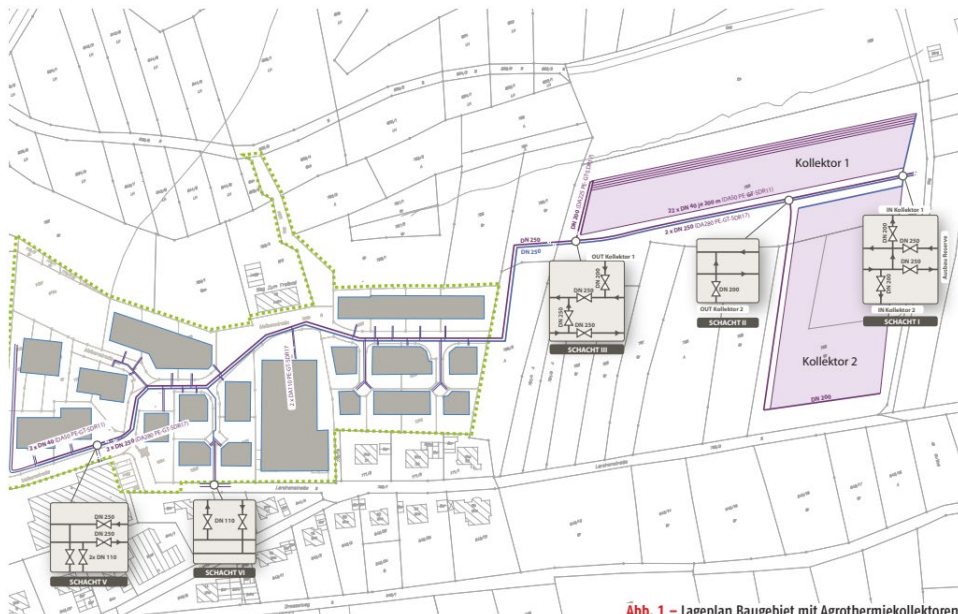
Lageplan Baugebiet mit Agrothermiekollektoren
